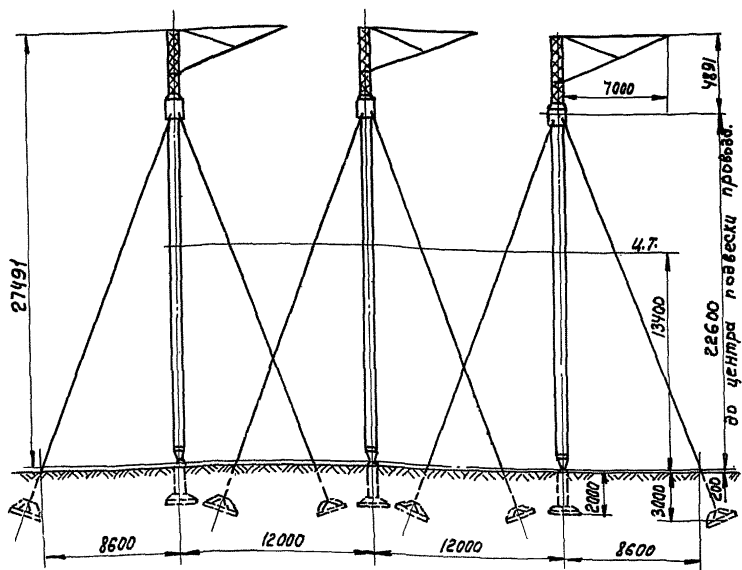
Общий вид и характеристика анкерно-угловой железобетонной опоры на оттяжках УБ-500-1.
